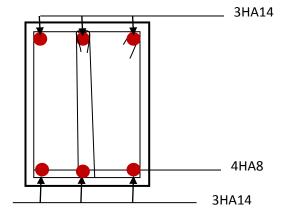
Ferraillage en travée d'une poutre secondaire.
